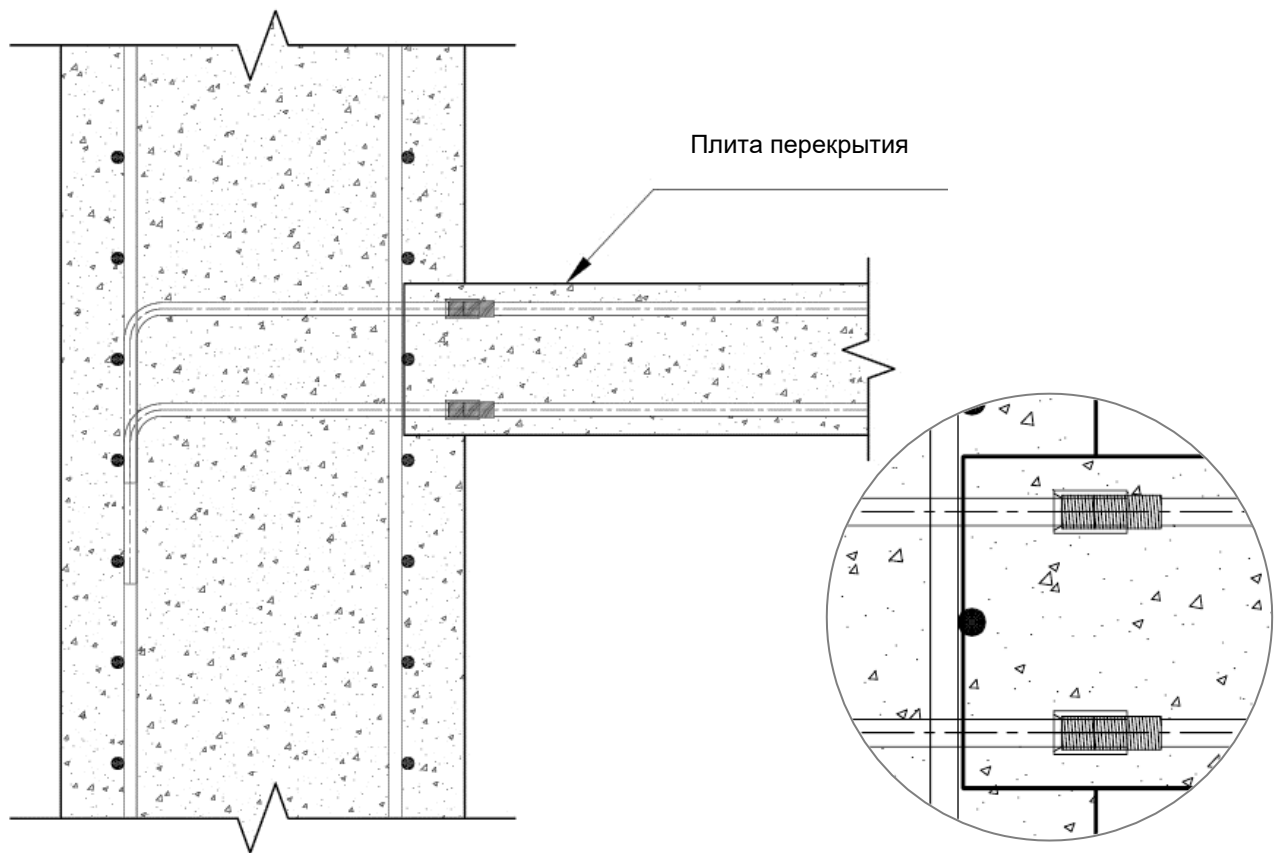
Бетонирование плиты перекрытия
